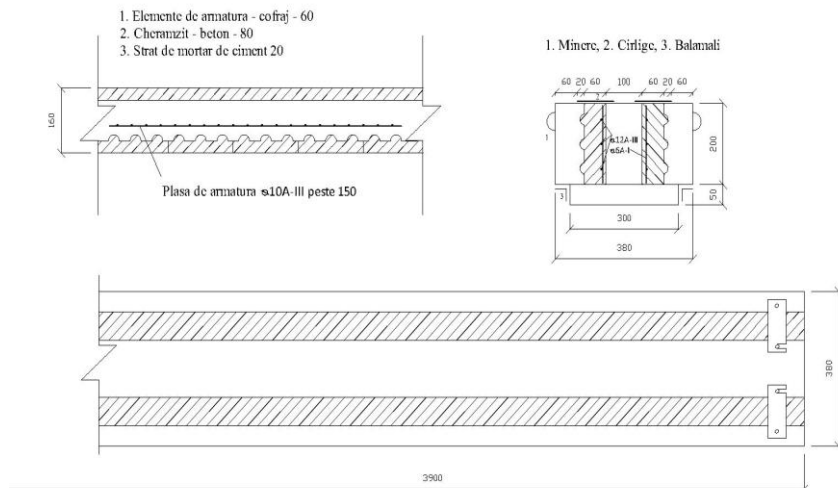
Cofrajul și construcția elementelor de armătură – cofraj
